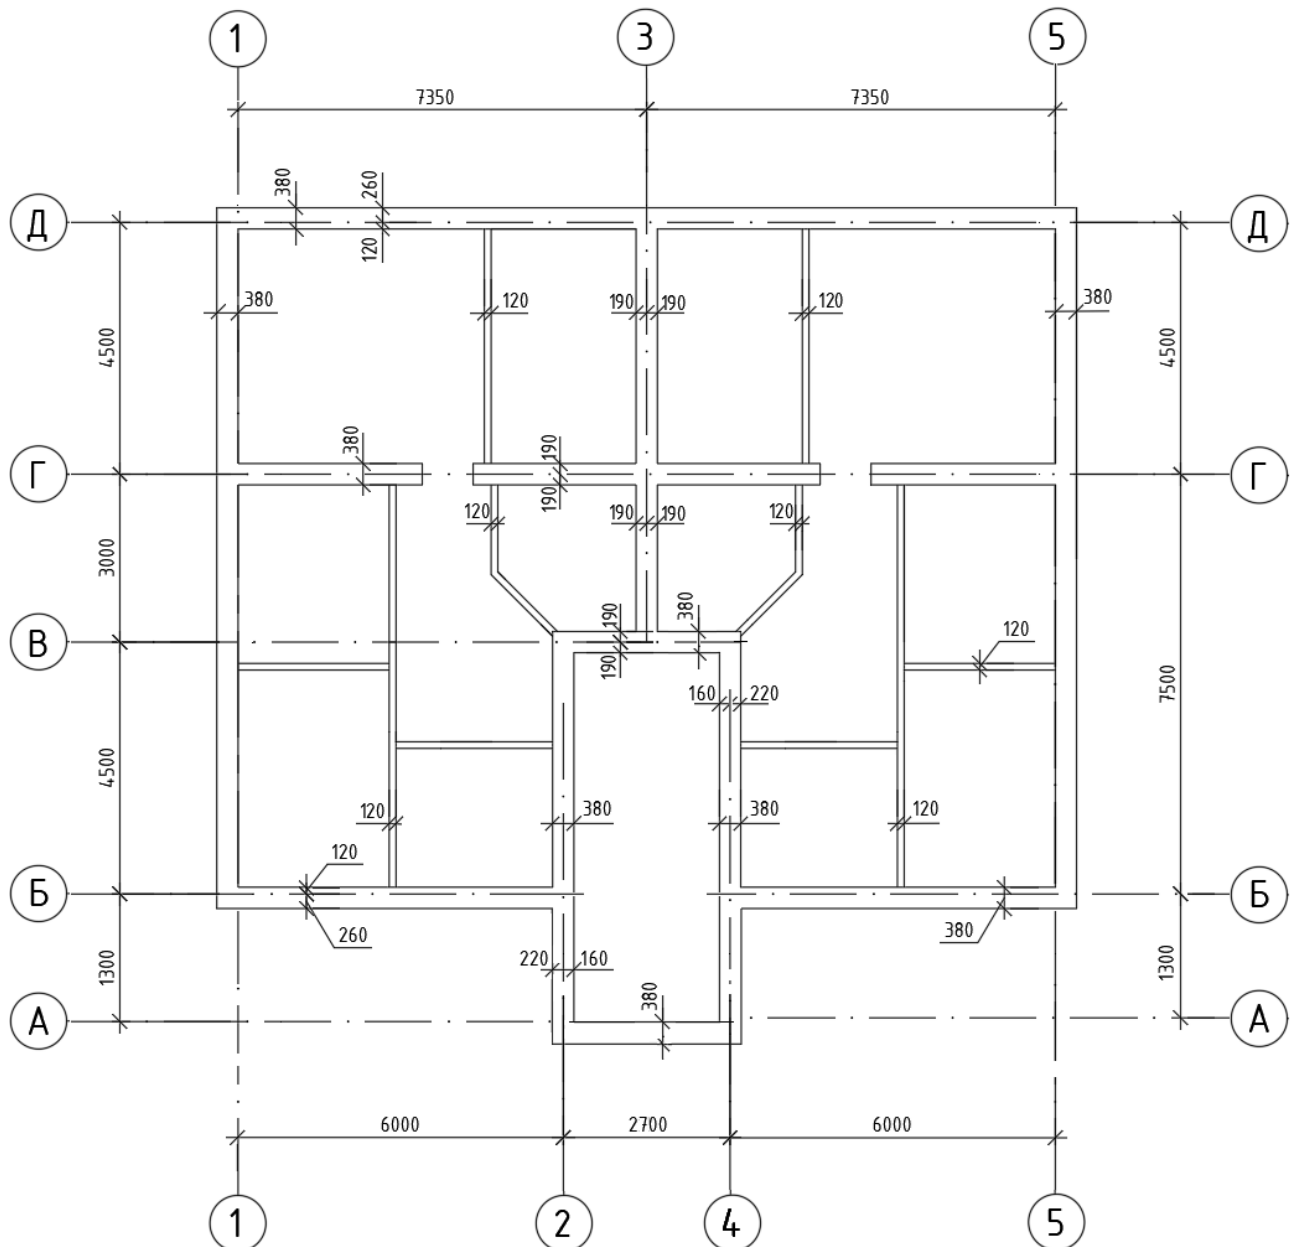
Побудова плану будівлі із вказівкою прийнятих розмірів товщини стін, перегородок і їхніх прив'язок до осей
